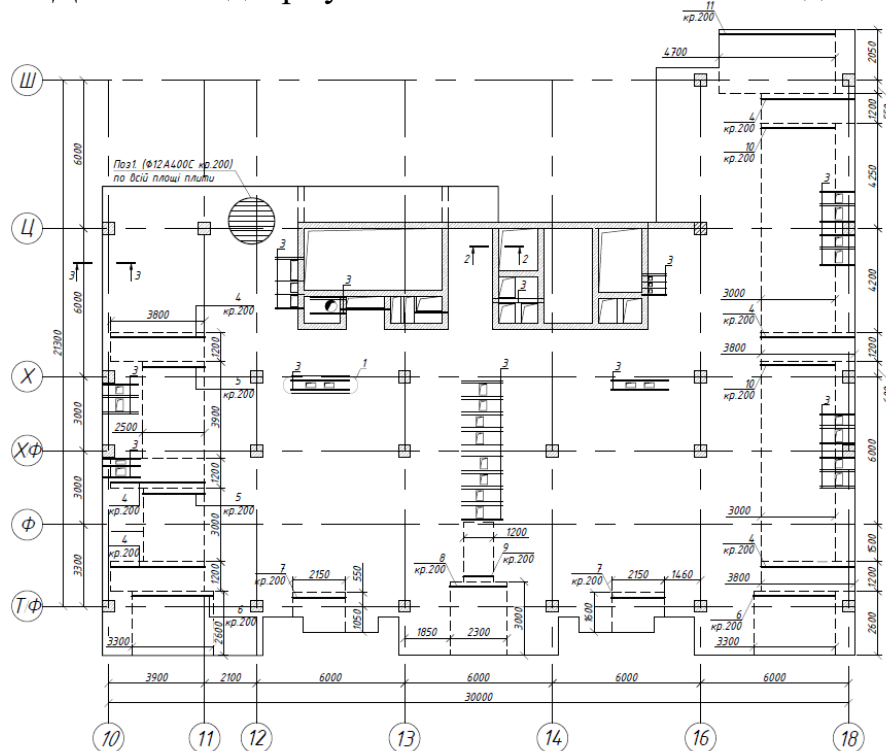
Схема розташування нижньої арматури вздовж осі Х.
